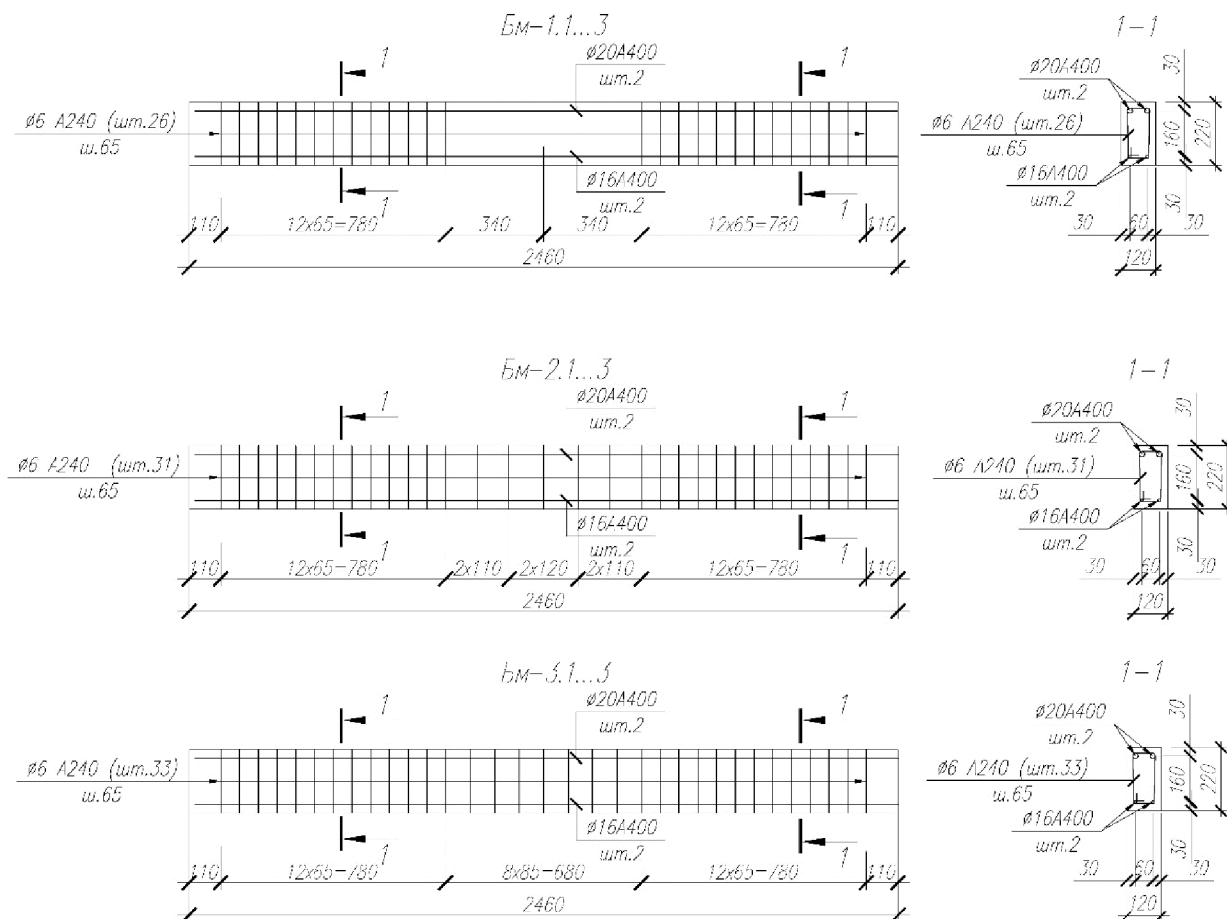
Принятое армирование железобетонных балок Бм-1.1...3, Бм-2.1...3, ... Бм-3.1...3.
